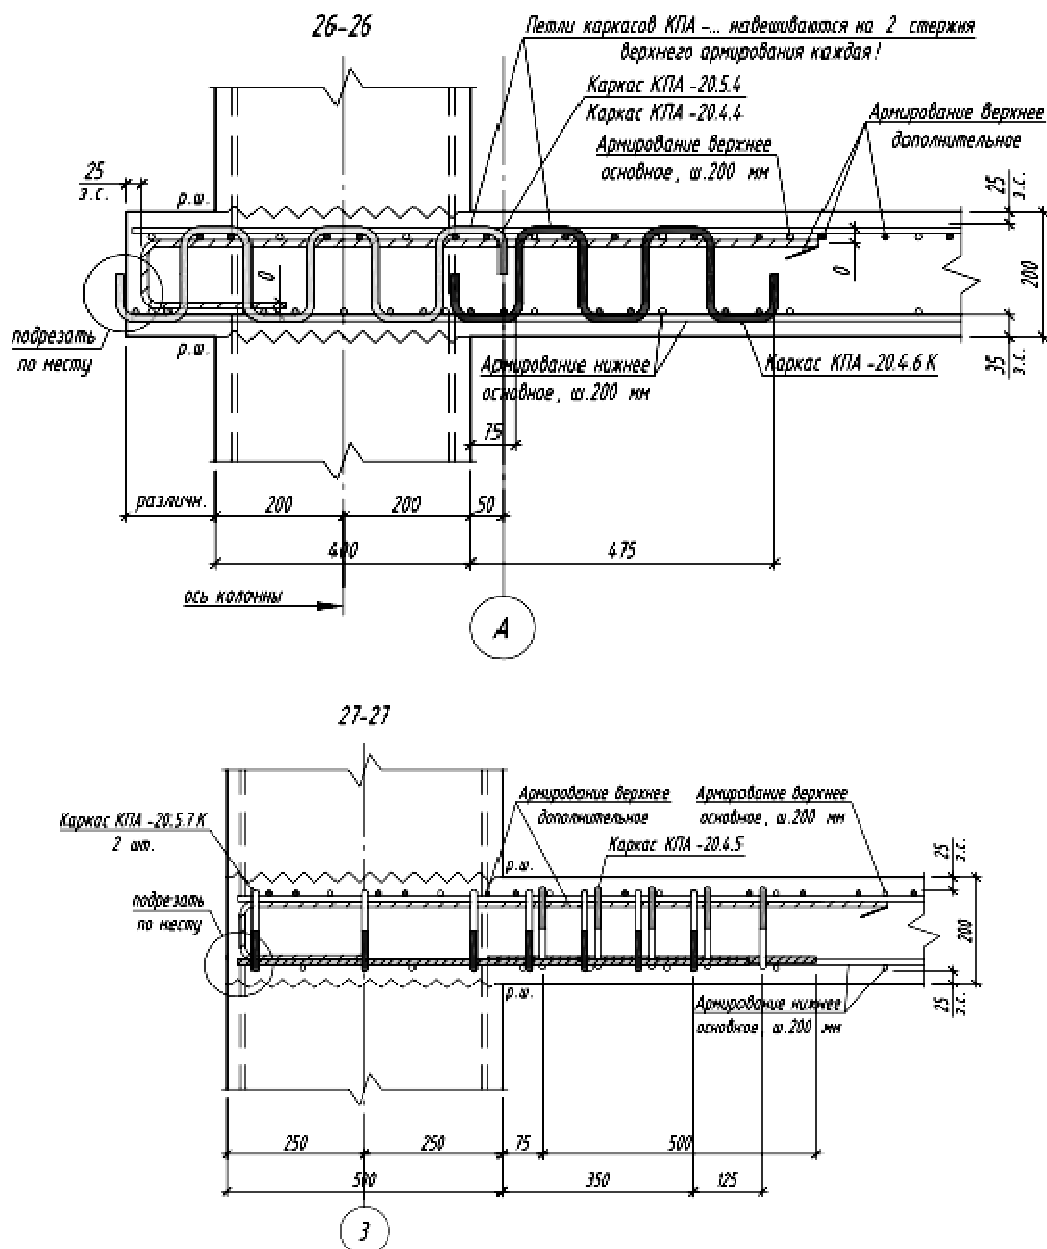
Узел поперечного армирования плиты перекрытия типового этажа
